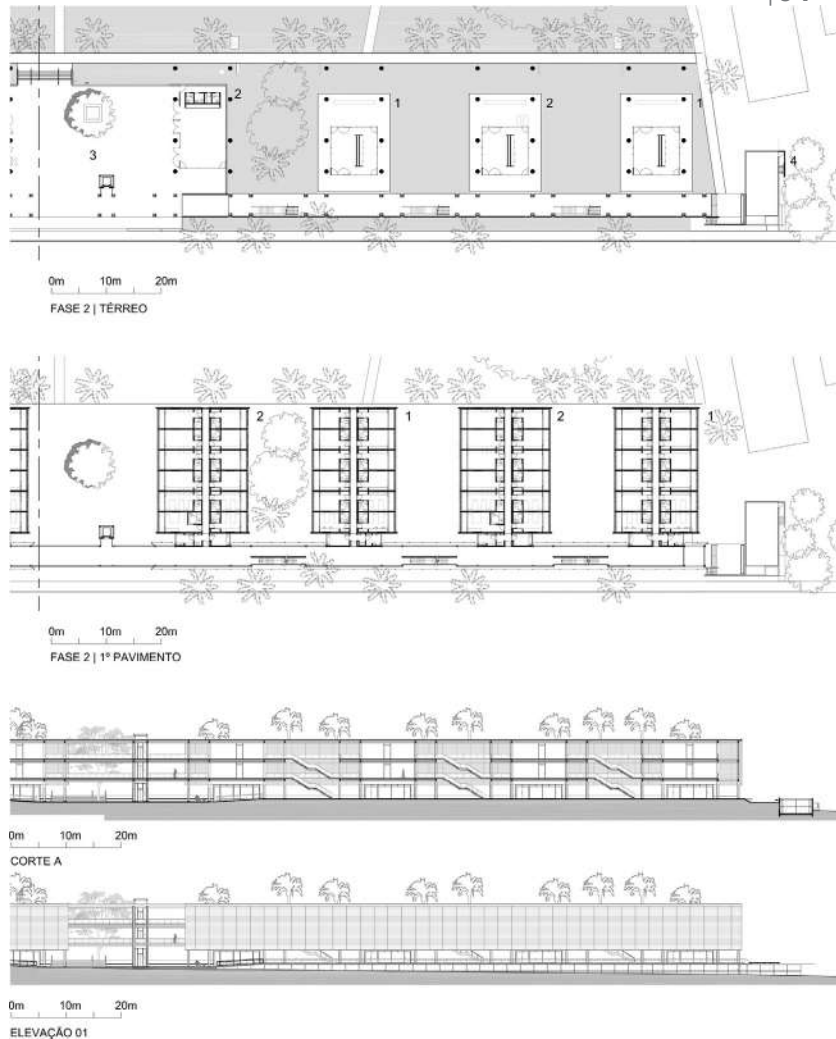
Plantas y elevaciones de la fase 2 del proyecto
